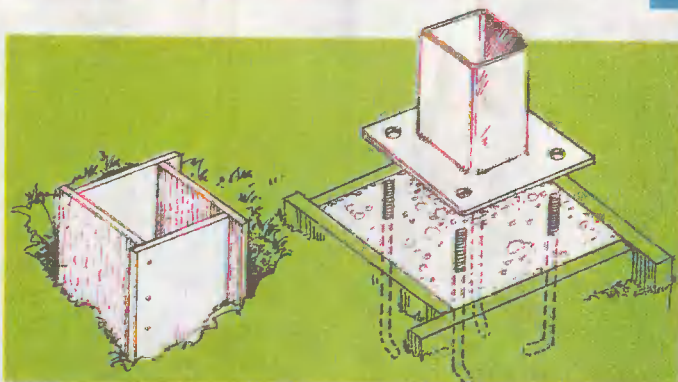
Опалубка под бетонный столбик сделана из четырех досок, в качестве анкеров забетонированы отрезки арматуры с резьбой на концах.
